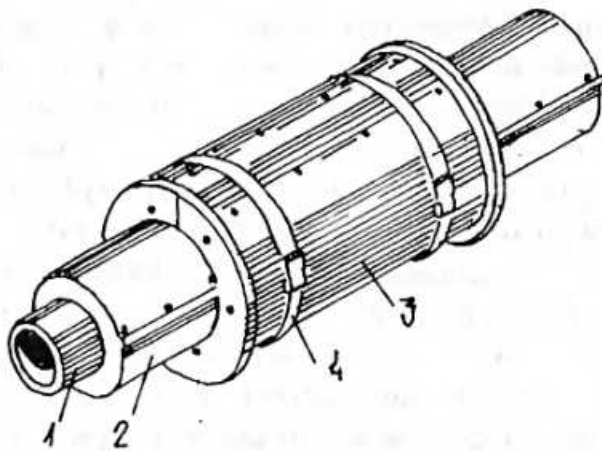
Монтаж повнозбірних конструкцій (півфутлярів) на фланцевих з'єднаннях: 1 - трубопровід; 2- теплоізоляція; 3- півфутляр; 4 - хомут
